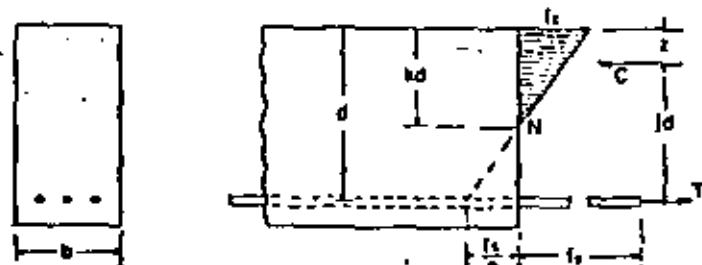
VIGAS CON REFUERZO PARA TENSION
